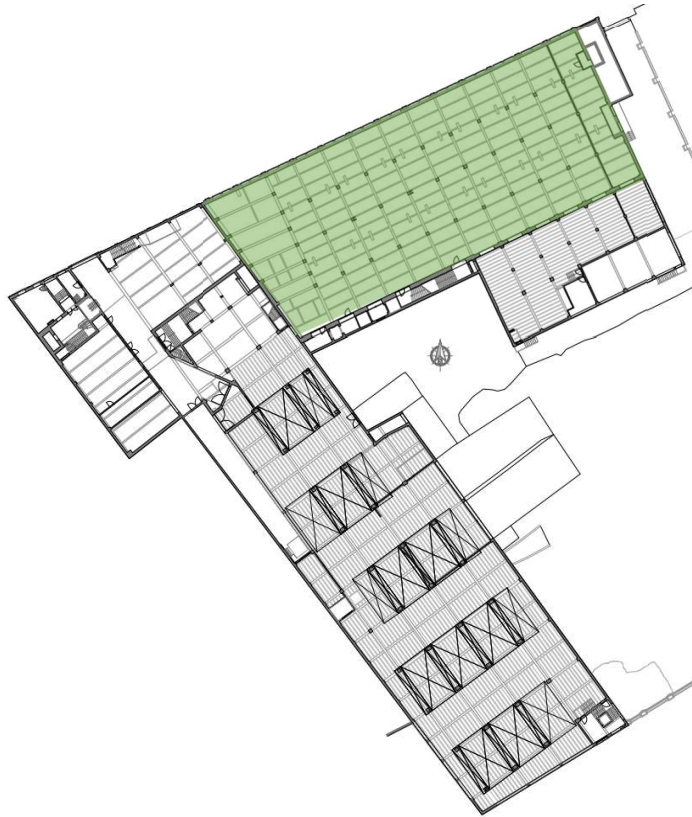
Découpage des structures dans le plan avec la partie conservée en vert
